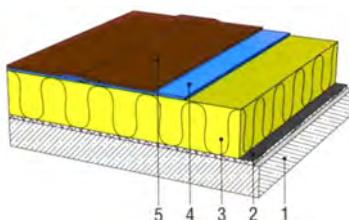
Однослойное теплоизоляционное решение кровли с двухслойным наплавляемым гидроизоляционным ковром и клеевым креплением: 1 — несущая железобетонная плита покрытия; 2 — приклейка горячим битумом, выполняющая роль пароизоляции; 3 — теплоизоляционный слой из плит РУФ БАТТС; 4 — нижний слой наплавляемого гидроизоляционного ковра; 5 — верхний наплавляемый гидроизоляционный ковер
